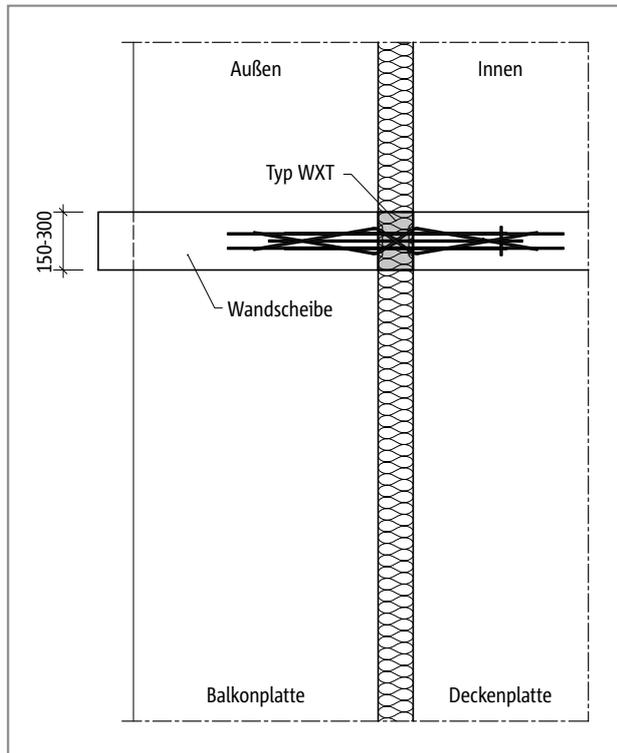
Schöck Isokorb® Typ WXT: Grundriss; Balkonkonstruktion mit wärmege-
